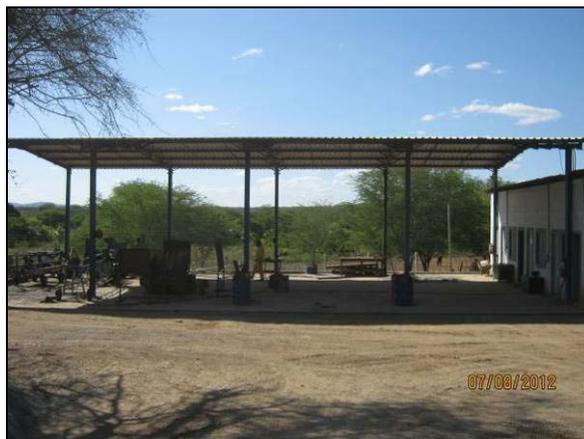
Oficina mecânica com estruturas adequadas na área do canteiro de obras (ago/2012).
